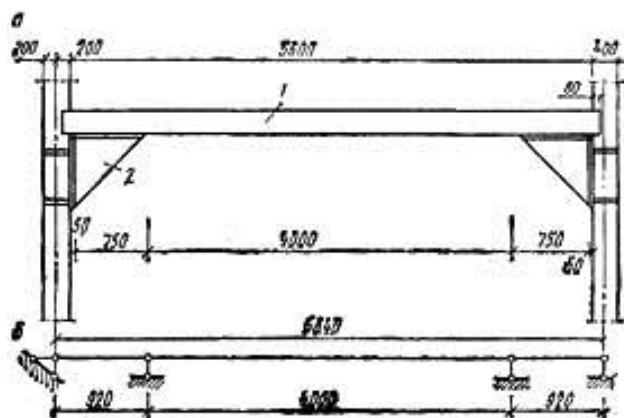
Усиление балки изменением расчетной схемы: а – конструкция; б – расчетная схема; 1 – существующая балка; 2 – подводка консоли
